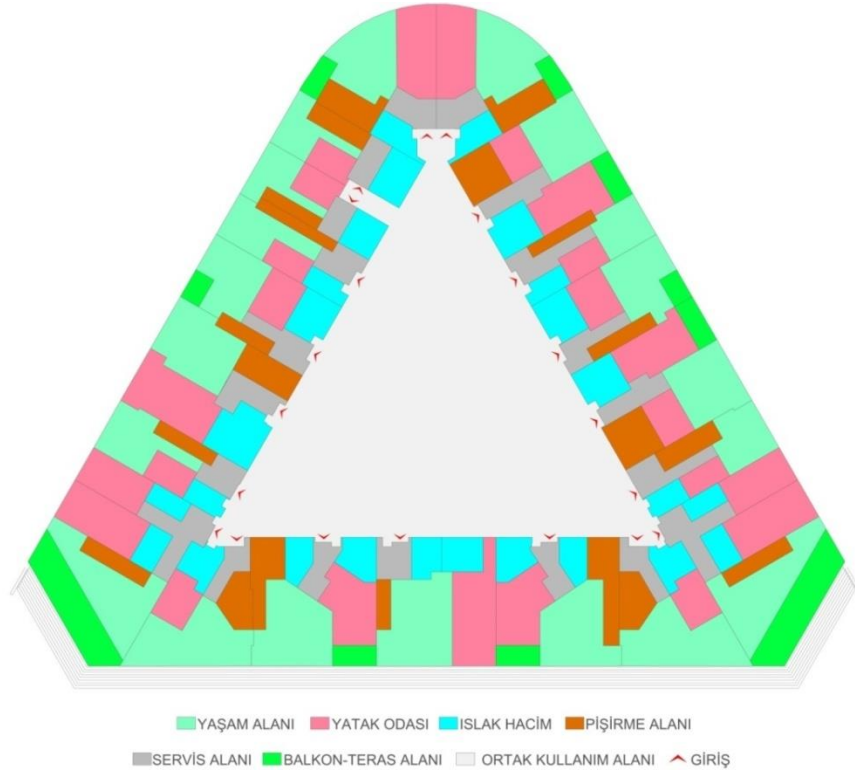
Skyland Terasevler Konut Bloğu Kat Planı (Eroğlu Gayrimenkul Geliştirme)
